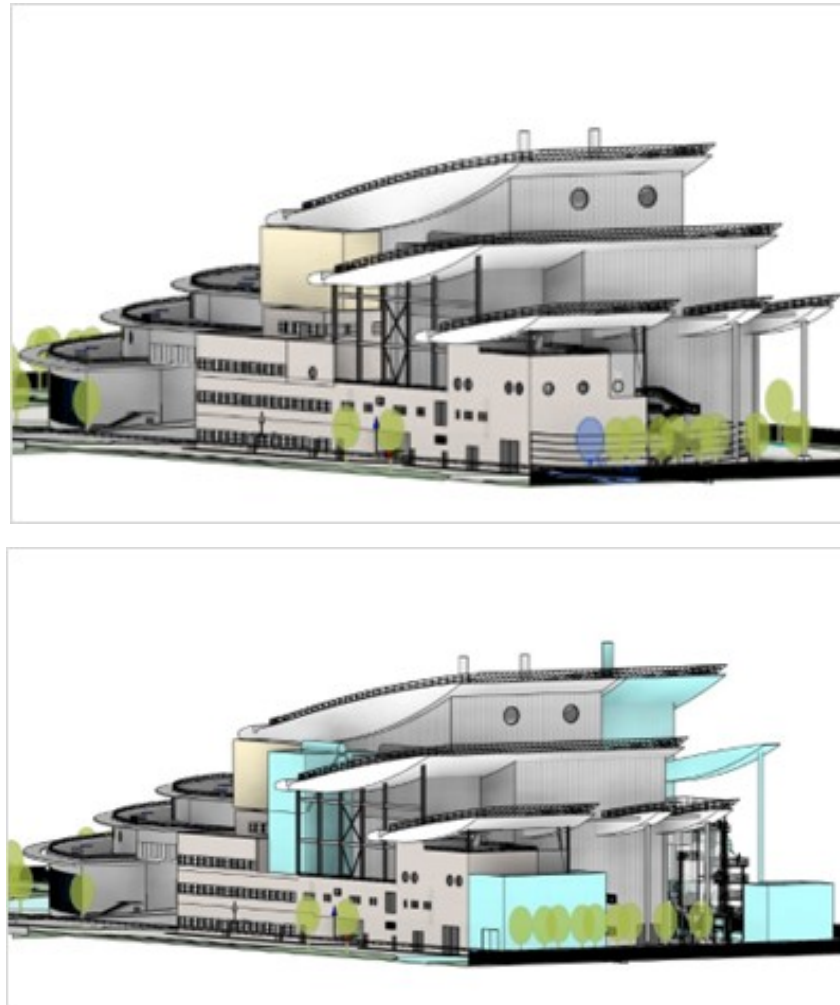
Intégration des nouvelles installations au bâtiment existant
